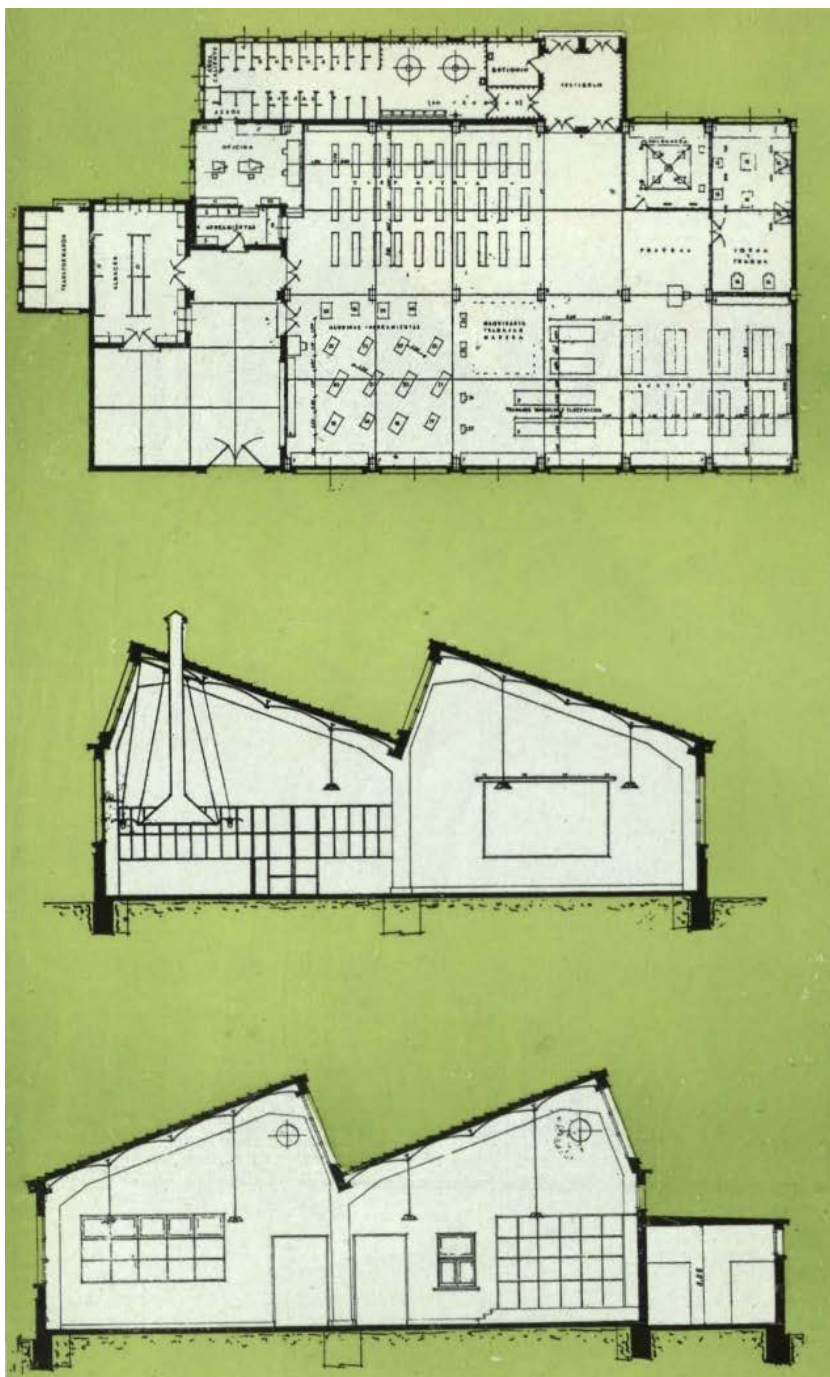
Plano. Pabellón de talleres, planta y secciones, por el arquitecto Alejandro Allanegui, abril de 1951 (*Revista Nacional de Arquitectura*, enero de 1954, colección privada).
